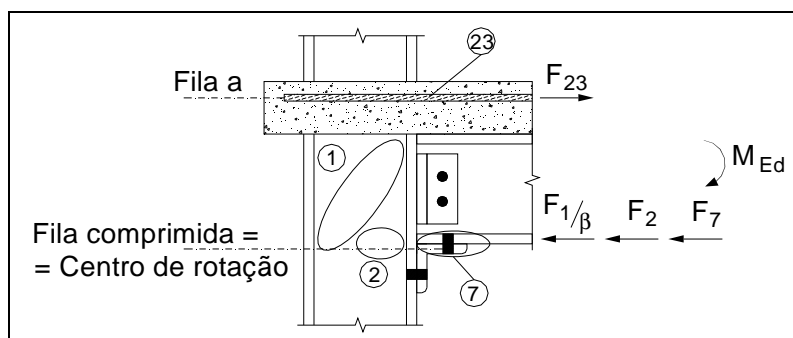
Ligação mista com cantoneiras de alma e assento apenas com fila traccionada a.
